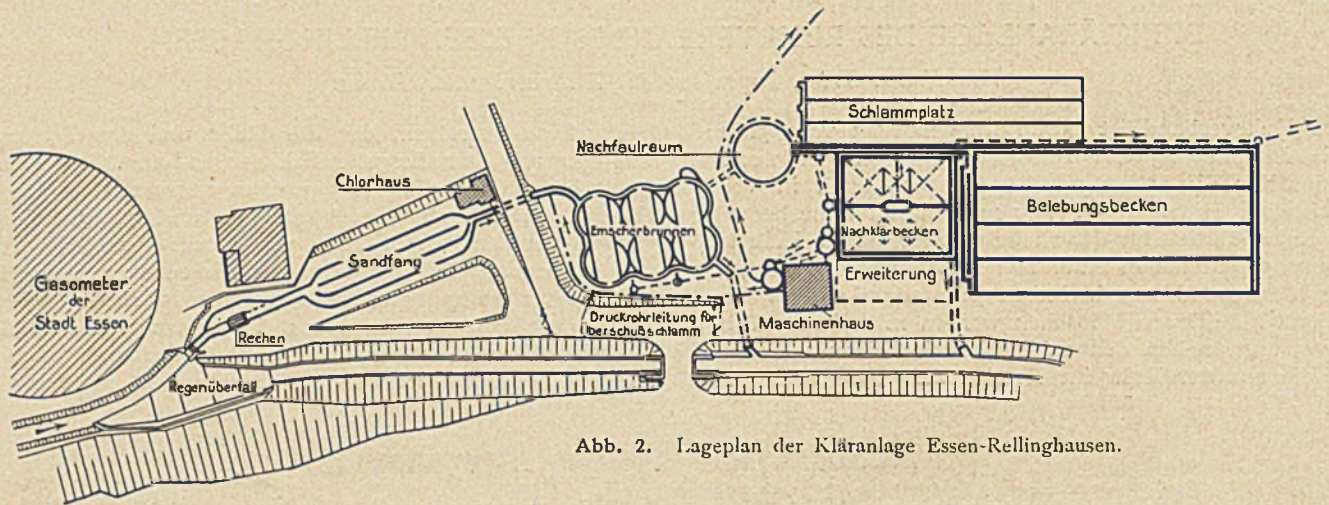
Lageplan der Kläranlage Essen-Rellinghausen.
